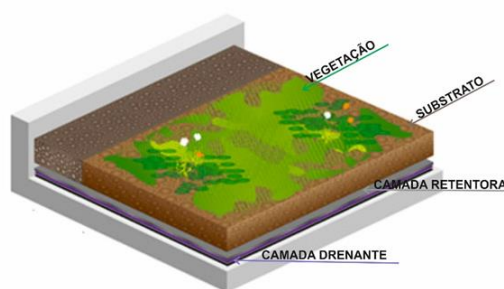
Desenho esquemático da estrutura do telhado verde tipo extensivo. Fonte:
